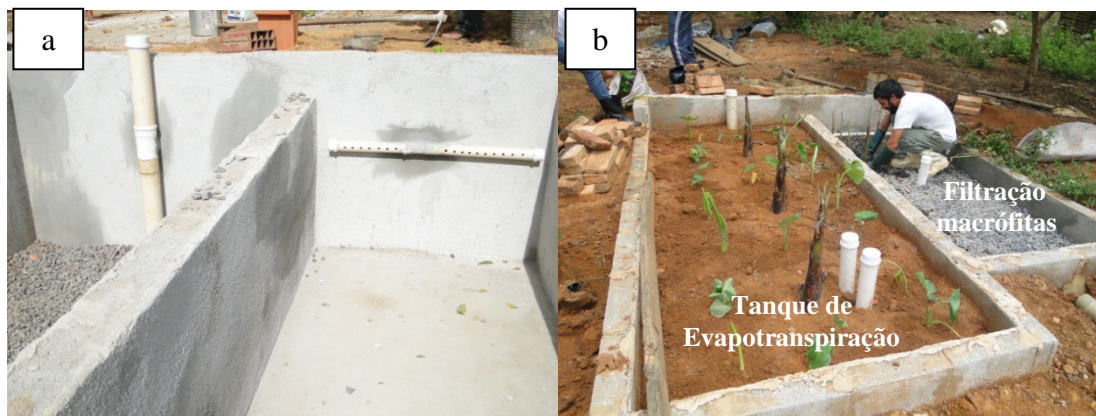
Detalhe construtivo do sistema (a); plantio das mudas (b).
